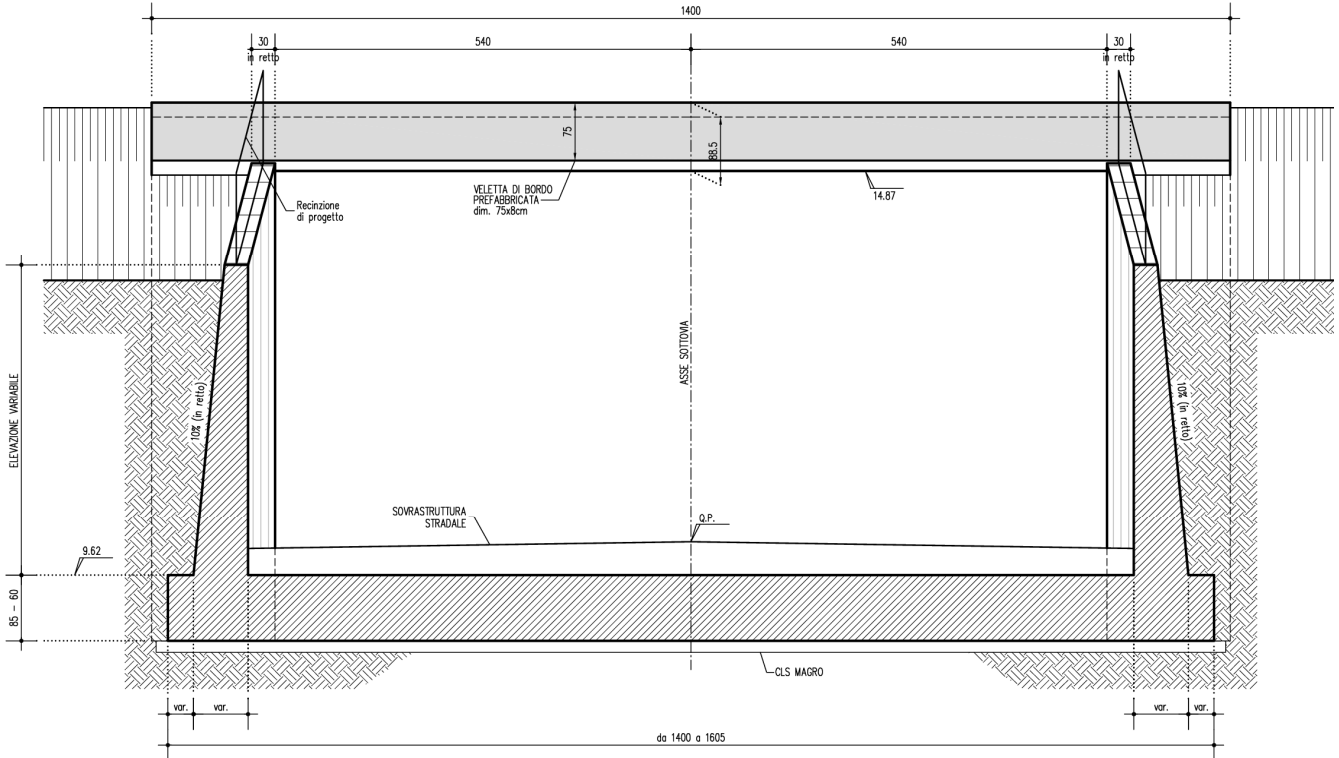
SEZIONE TRASVERSALE MURI AD U
